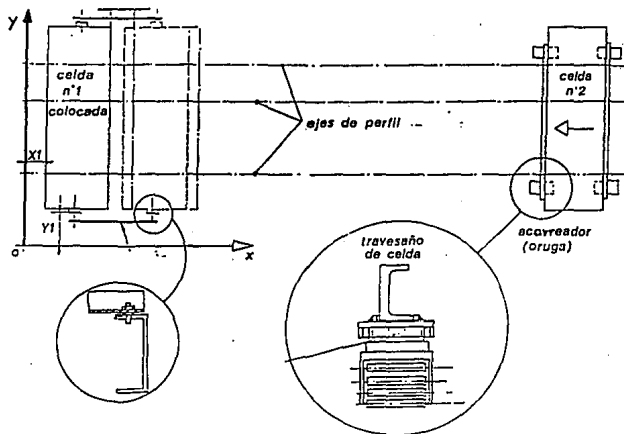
Esquema que muestra el levantamiento de las celdas y el traslado de ellas dentro de la sala de montaje.
